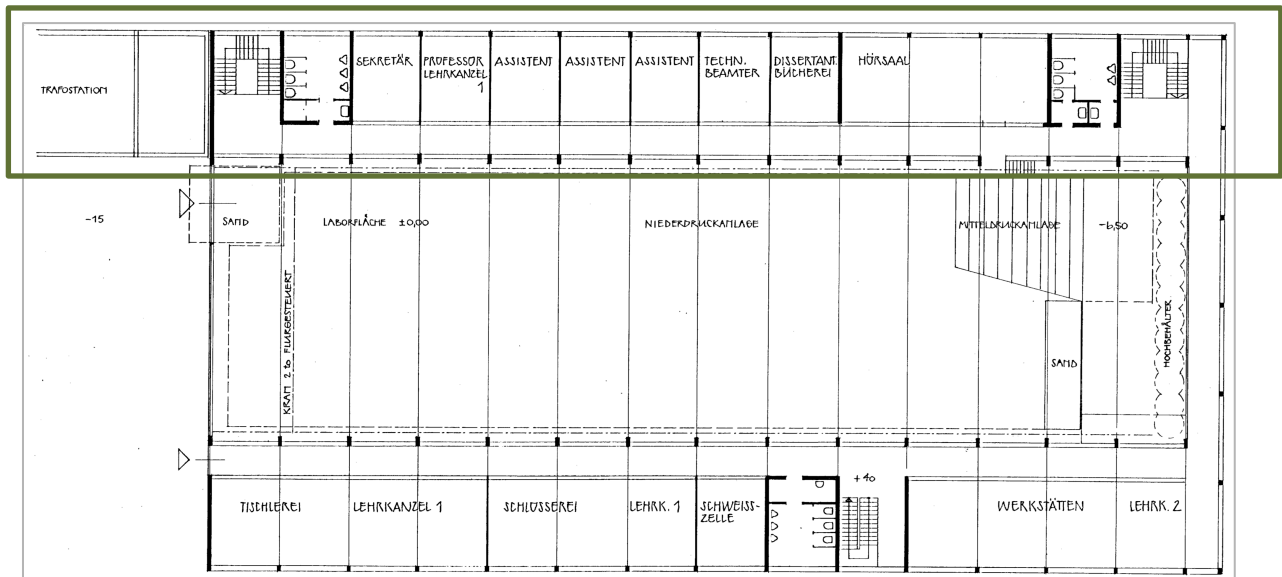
Grobe Darstellung des Grundrisses (EG) des Wasserbaulabors (Planscan)
